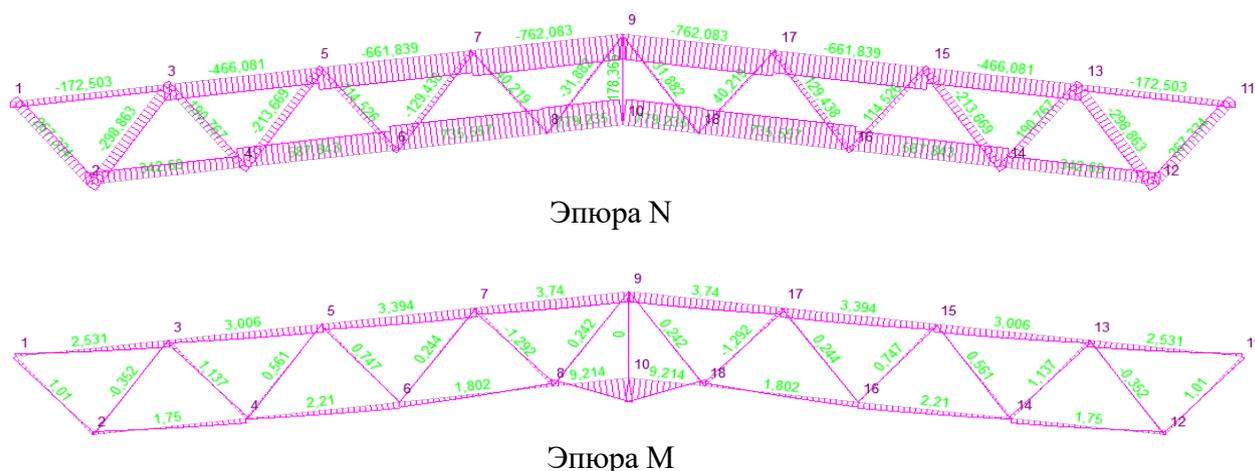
Эпюры усилий (M и N) в элементах фермы
